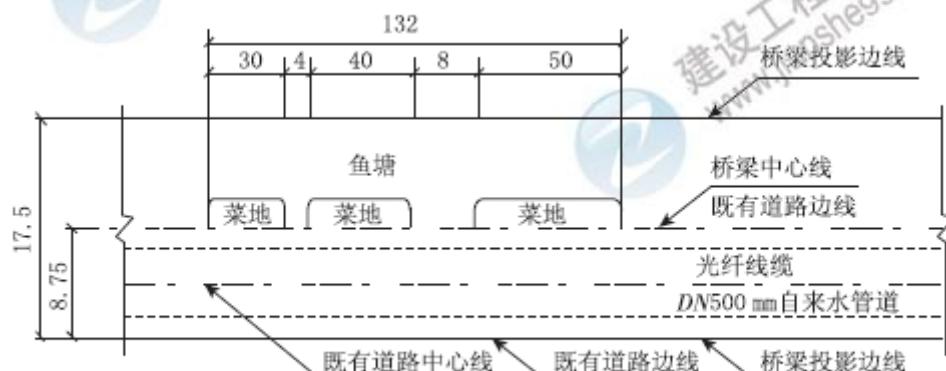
某市城郊改扩建高架桥平面布置示意图(单位: m)
